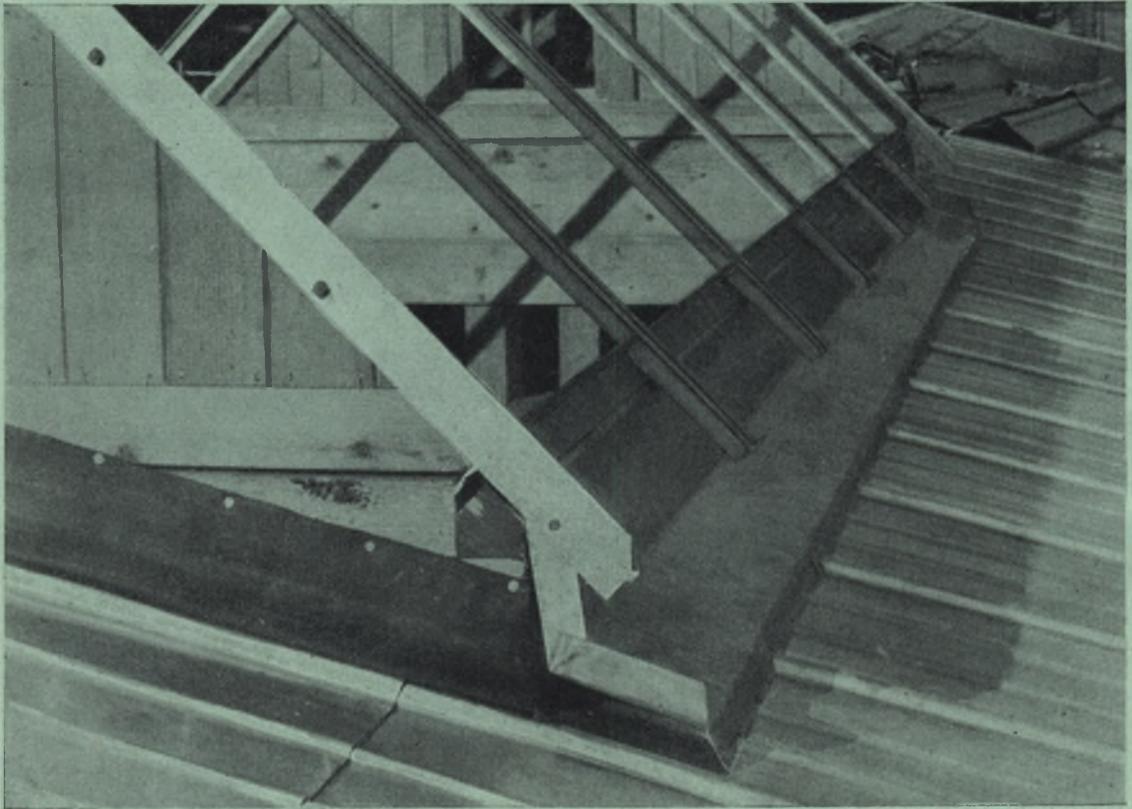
Anschluß der Oberlichter durch abgekantete Aluminiumbleche.
